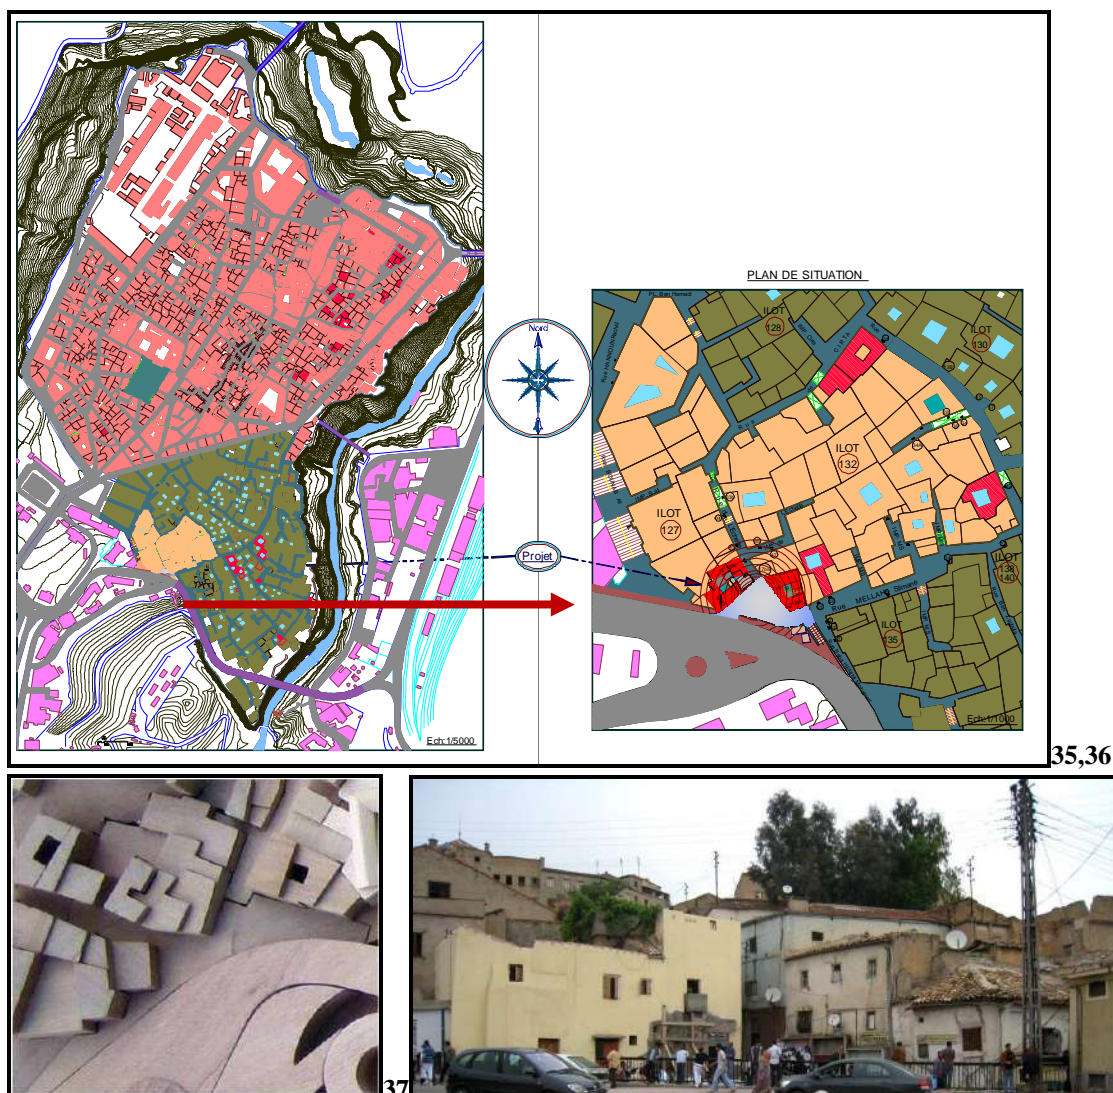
Localisation placette Bab El Djabia sur relevé master plan 2003. Figure 36 : Localisation de Bab El Djabia, sur fond de plan URBACO 1984. Figure 37: Maquette Master Plan. Bab El Djabia, Photo 50 : Vue sur l'espace Bab El Djabia, à partir du pont Sidi Rached. 2007.
